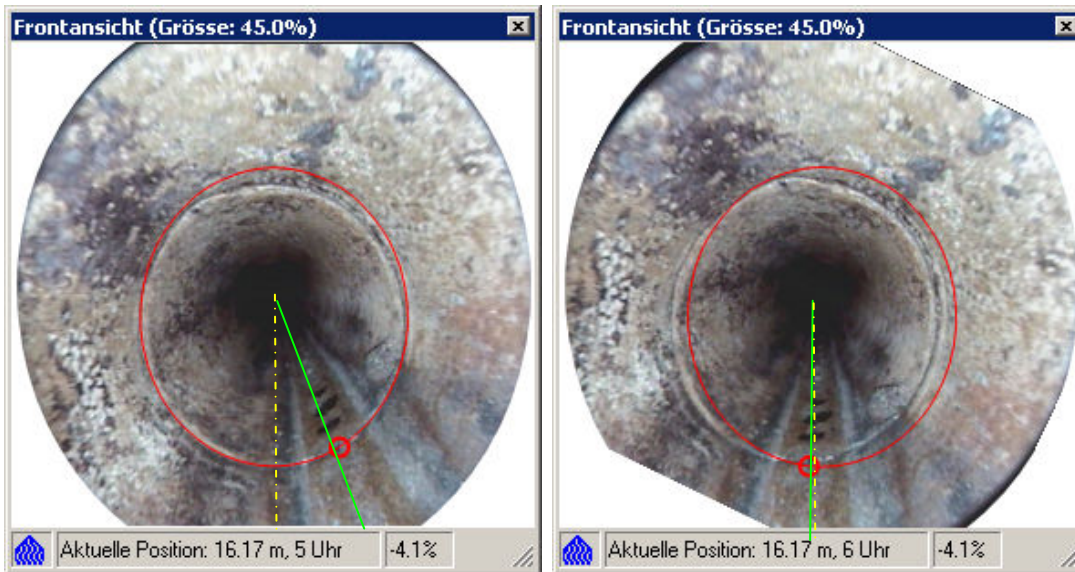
Die Frontansicht an derselben Stelle wie oben in der Übersicht ohne (links) und mit (rechts) axialer Rotationskorrektur.
